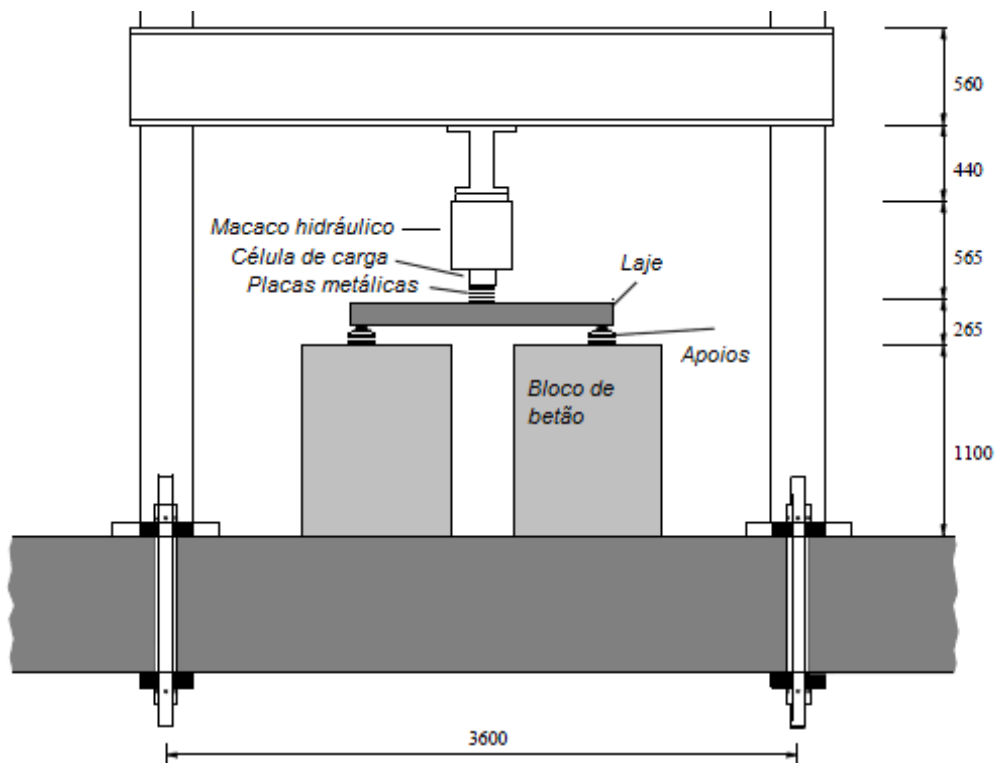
Sistema de ensaio das lajes da campanha experimental de Fernández Ruiz *et al.* (2013)
